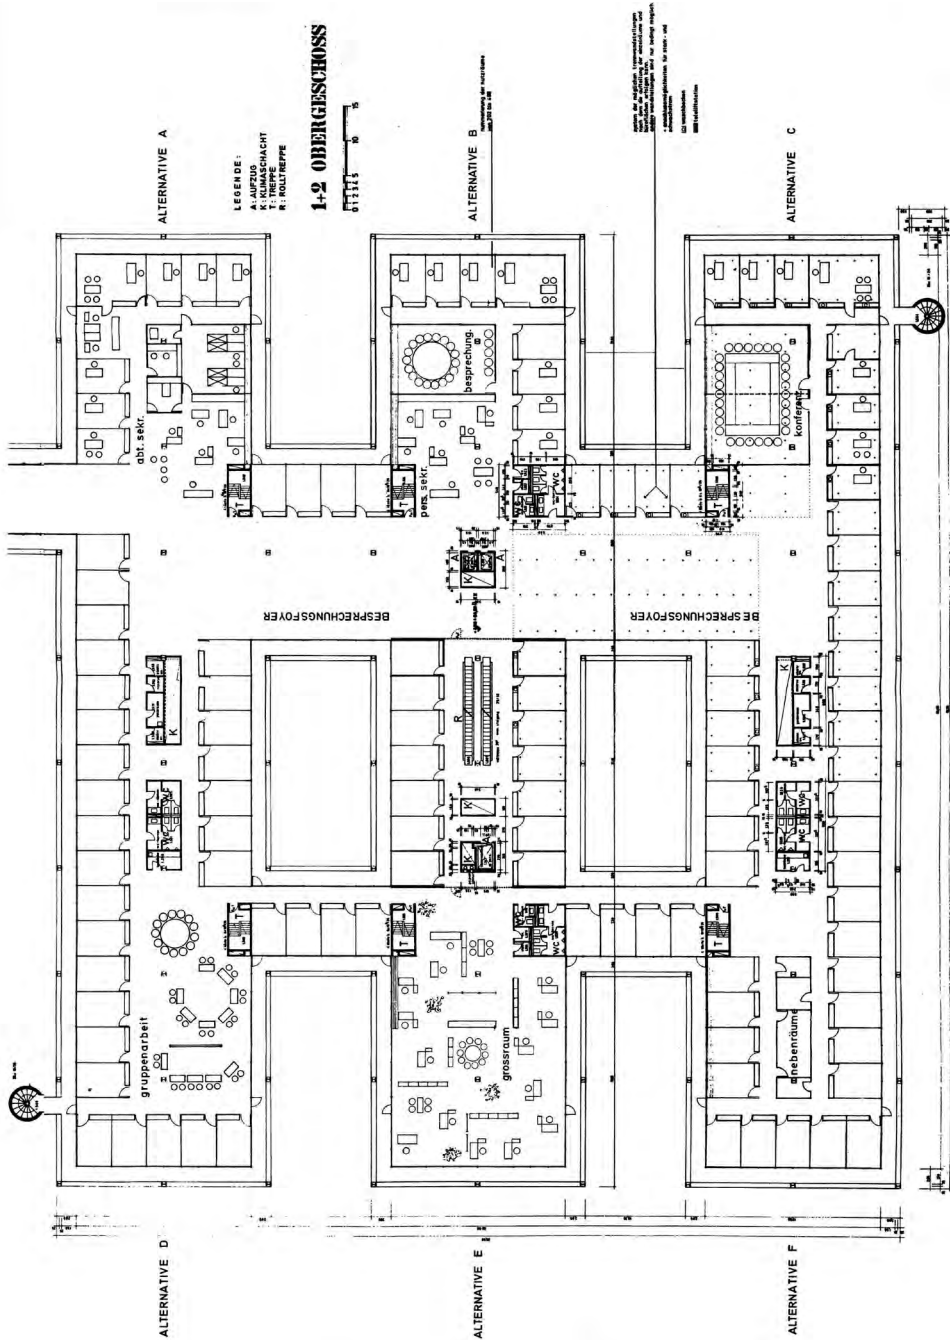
Planungsgruppe Stieldorf: Ausbauvarianten a bis f im flexiblen Grundriss des Abteilungsbaus. Planungsstand Januar 1972 .
